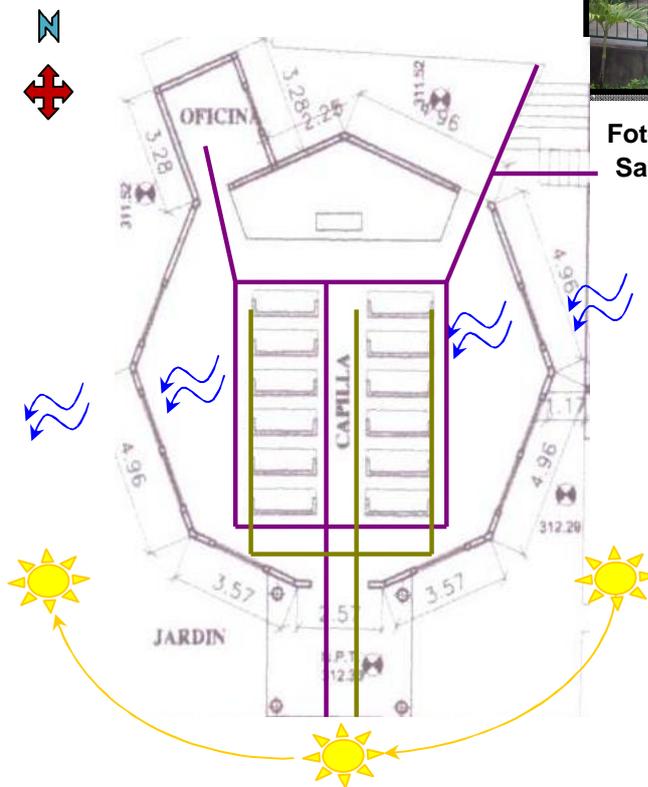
Planta Arquitectónica de Capilla. /Fuente:
